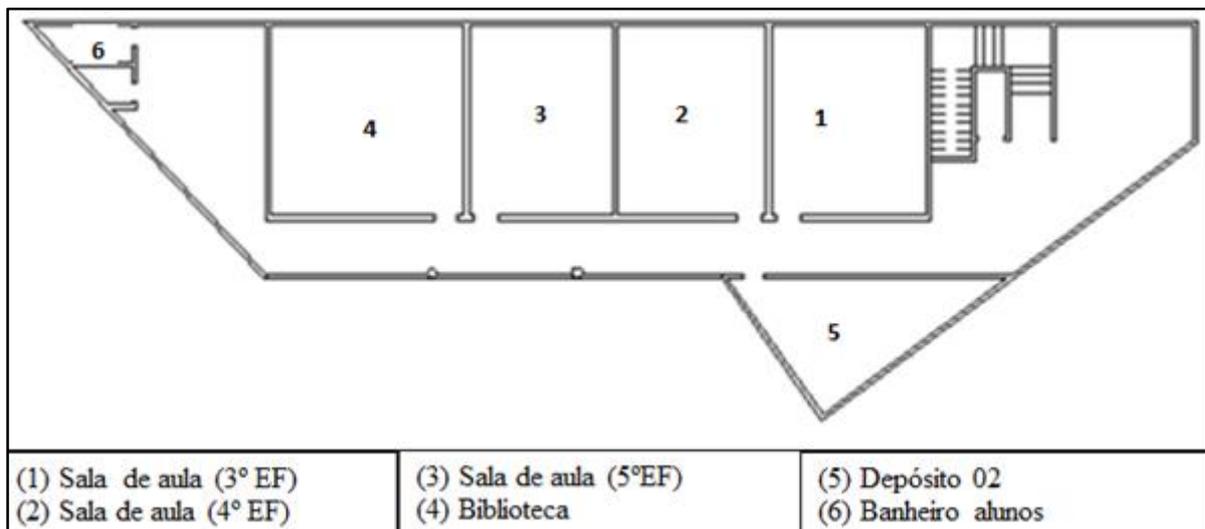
Planta baixa do primeiro pavimento - área total de 320,62 m²
